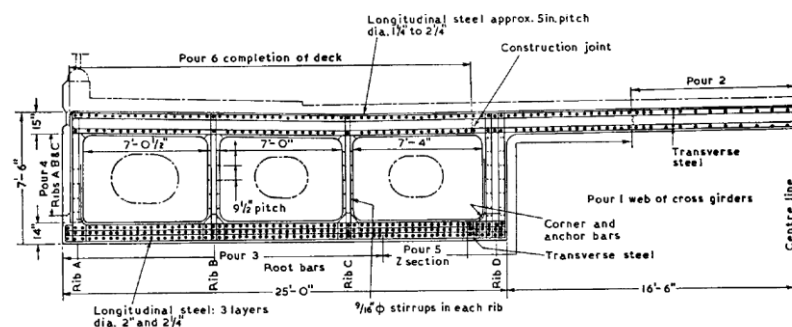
Corte Transversal do tabuleiro da Ponte Waterloo [13]
